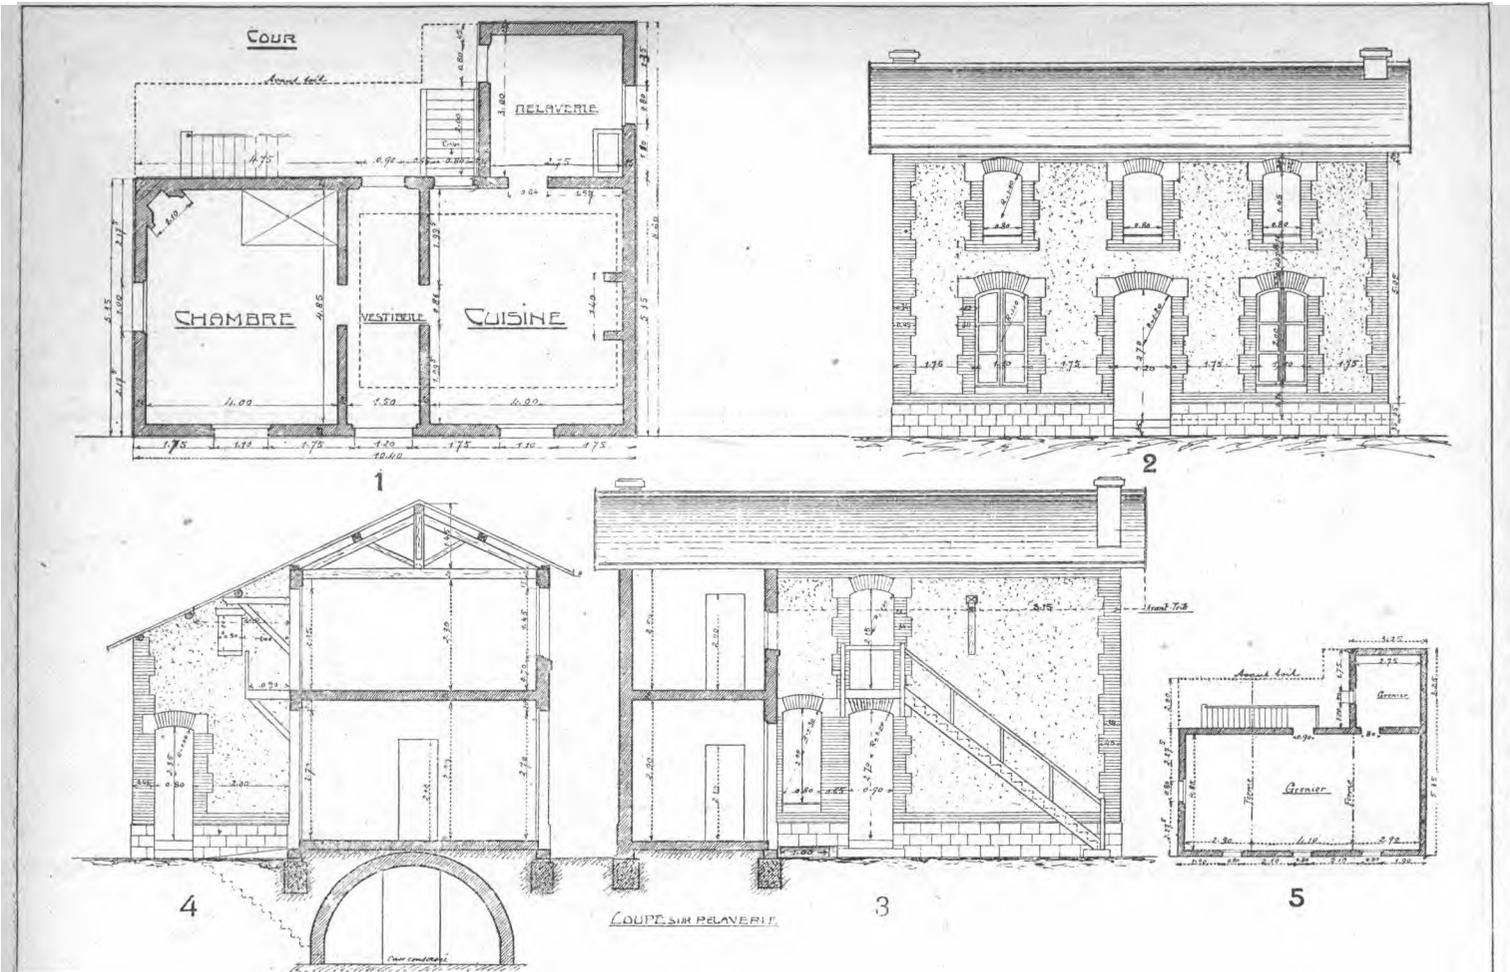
Habitation de l'exploitant de petite culture. 1. Plan du rez-de-chaussée; 2. Façade sur rue; 3. Façade sur cour; 4. Coupe; 5. Plan du grenier (échelle réduite).
